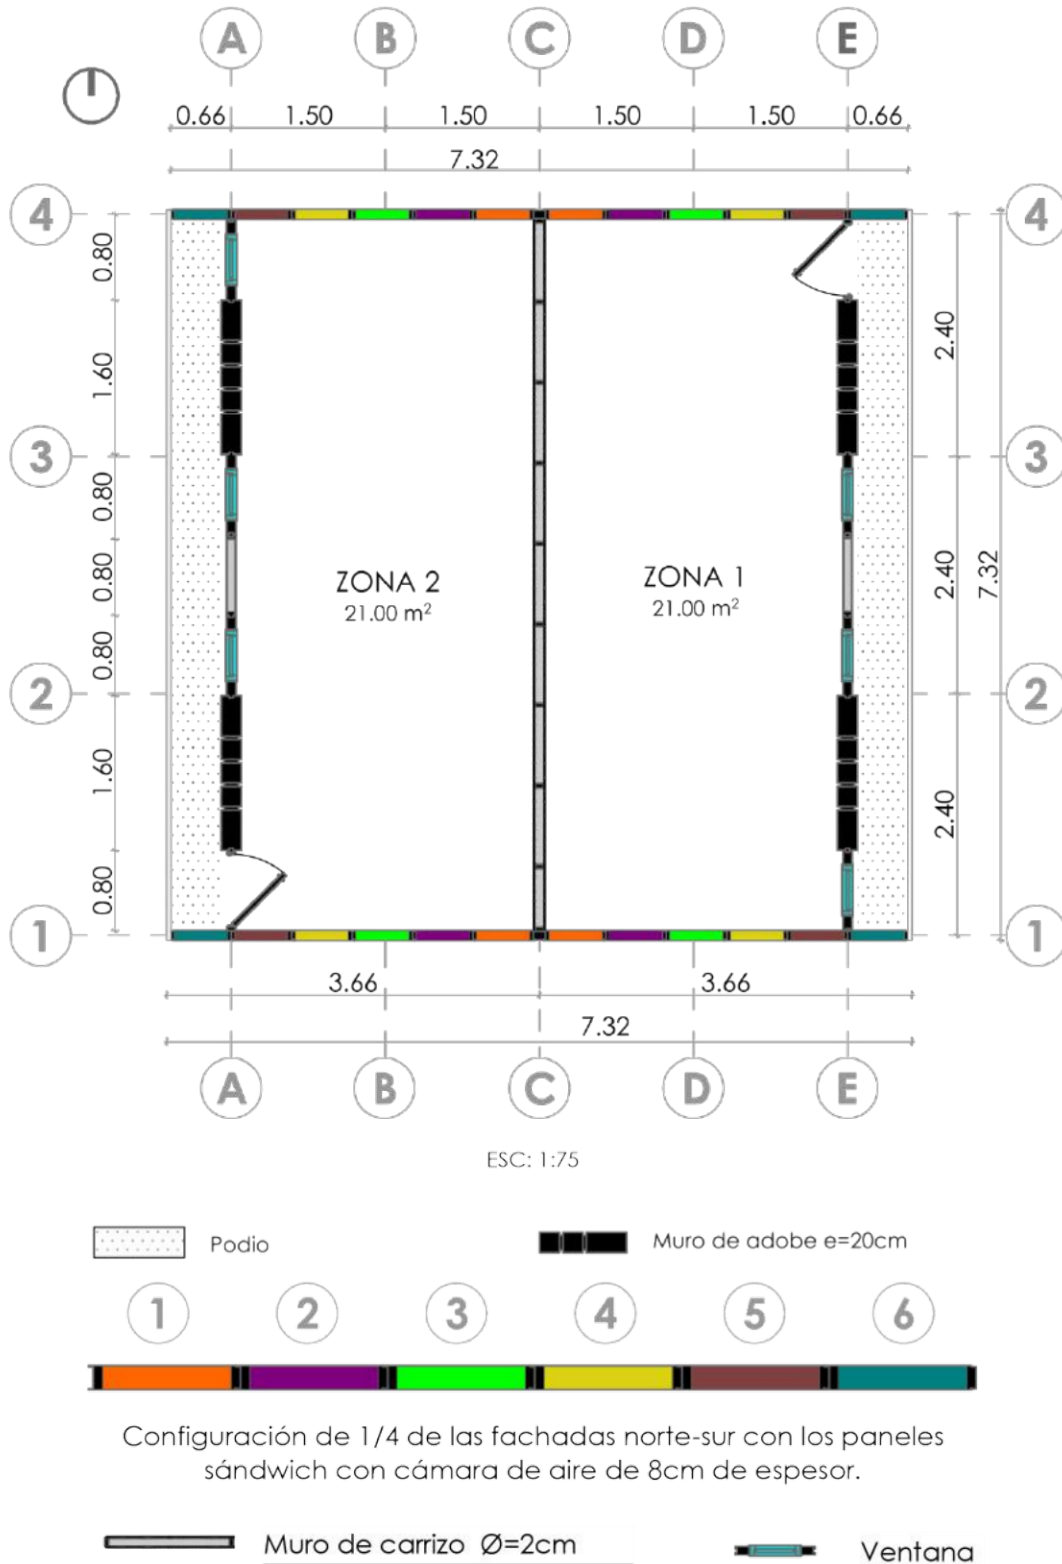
Planta arquitectónica, configuración de las fachadas norte y sur.
